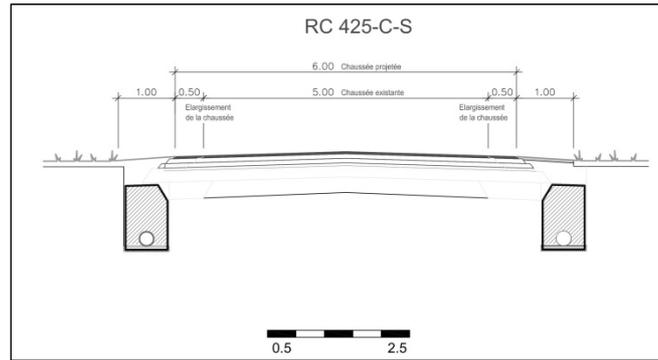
extrait plan de soumission, coupe type RC 425 (coupe 2)
